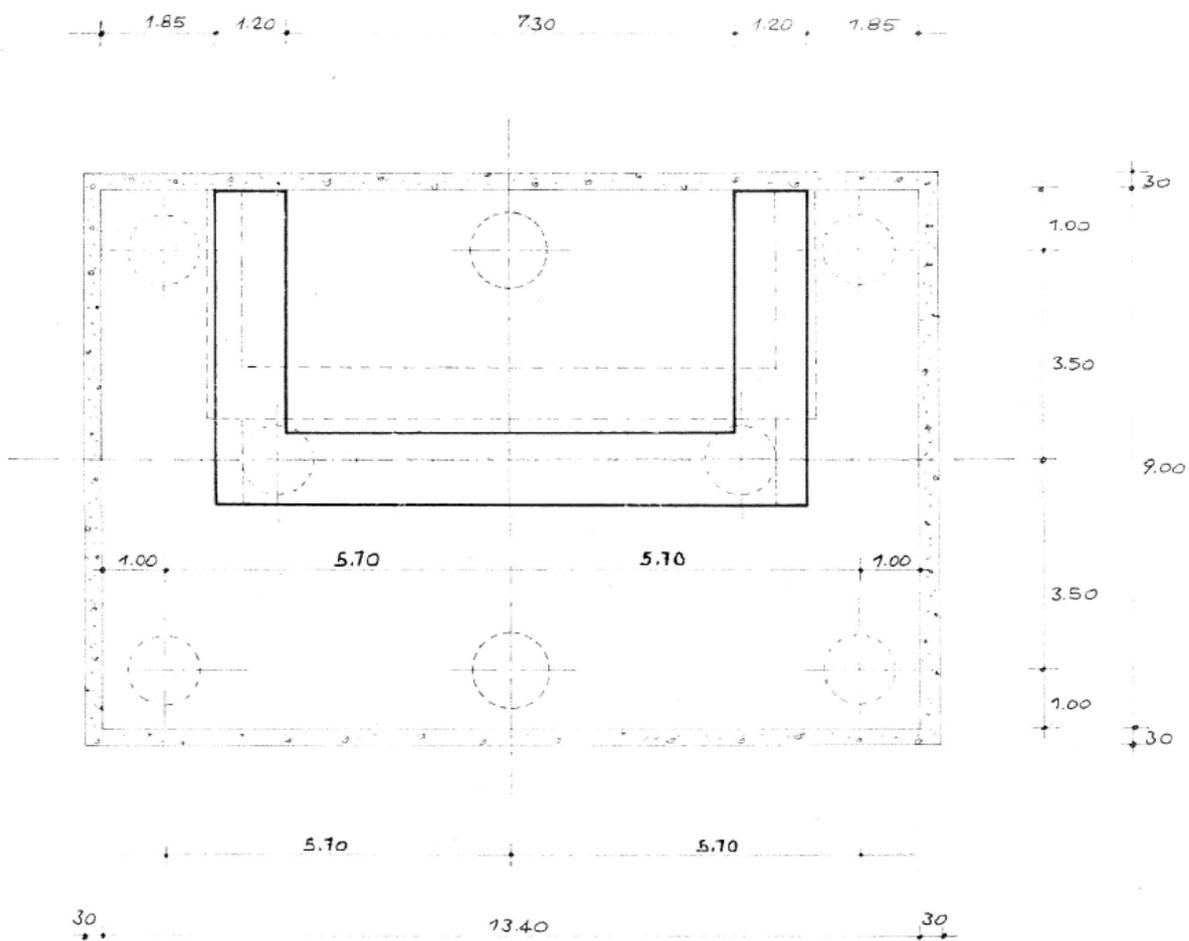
Impalcato a 3 travi in CAP – Spalla lato Palermo – Pianta
